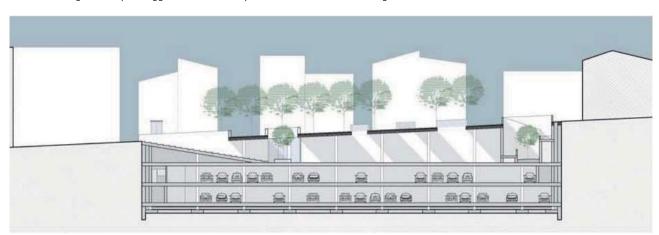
Progetto del parcheggio sotterraneo di piazza Università, sezione longitudinale
